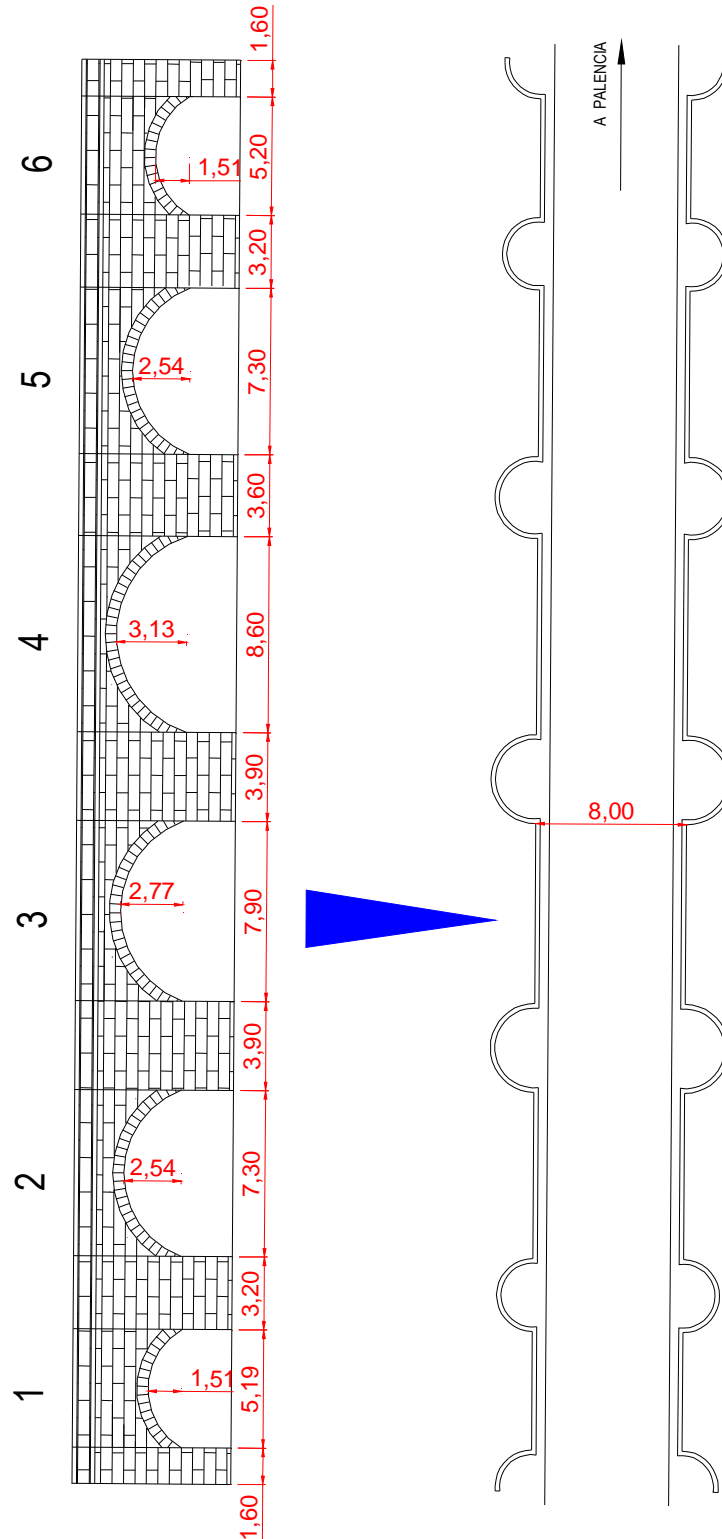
Planta y alzado de aguas abajo del puente de Don Guarín
